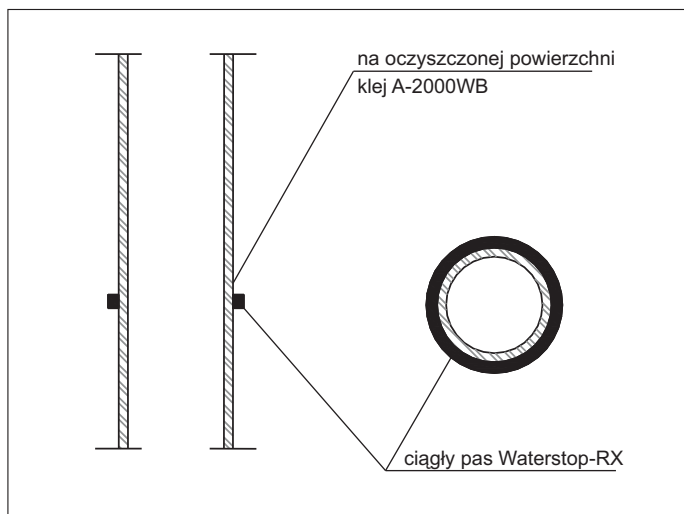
Typowe stosowanie taśm Waterstop RX w złączach elementów żelbetowych pojedynczo zbrojonych i betonowych.
